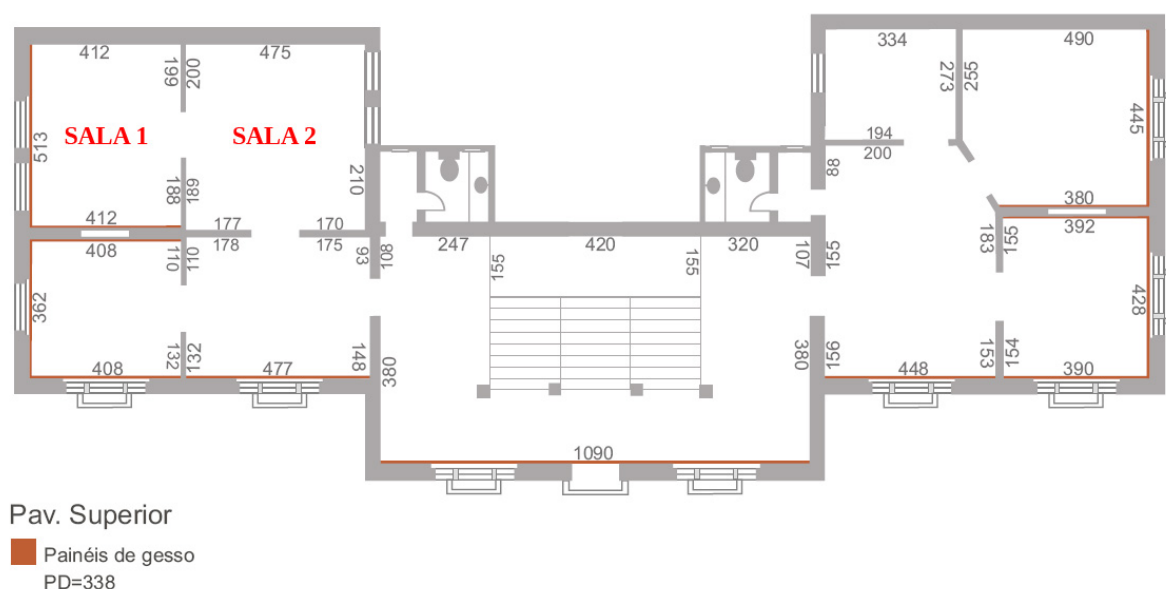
Planta baixa do pavimento superior do museu, mostrando as salas 1 e 2
